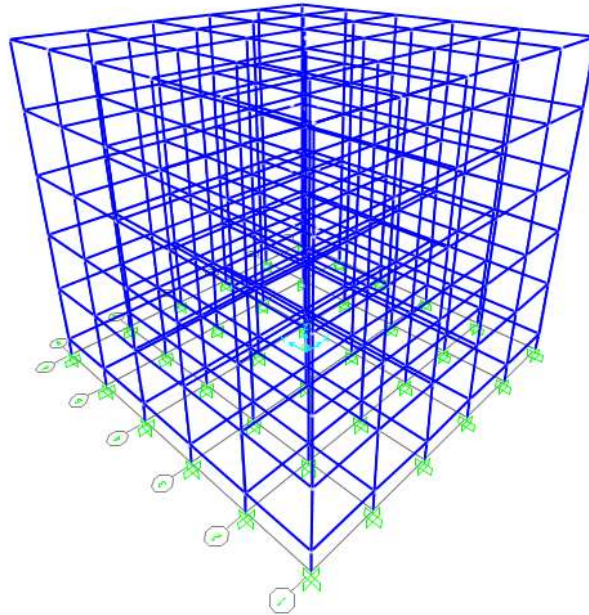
Vista tridimensional del modelado de los pórticos en SAP 2000.
